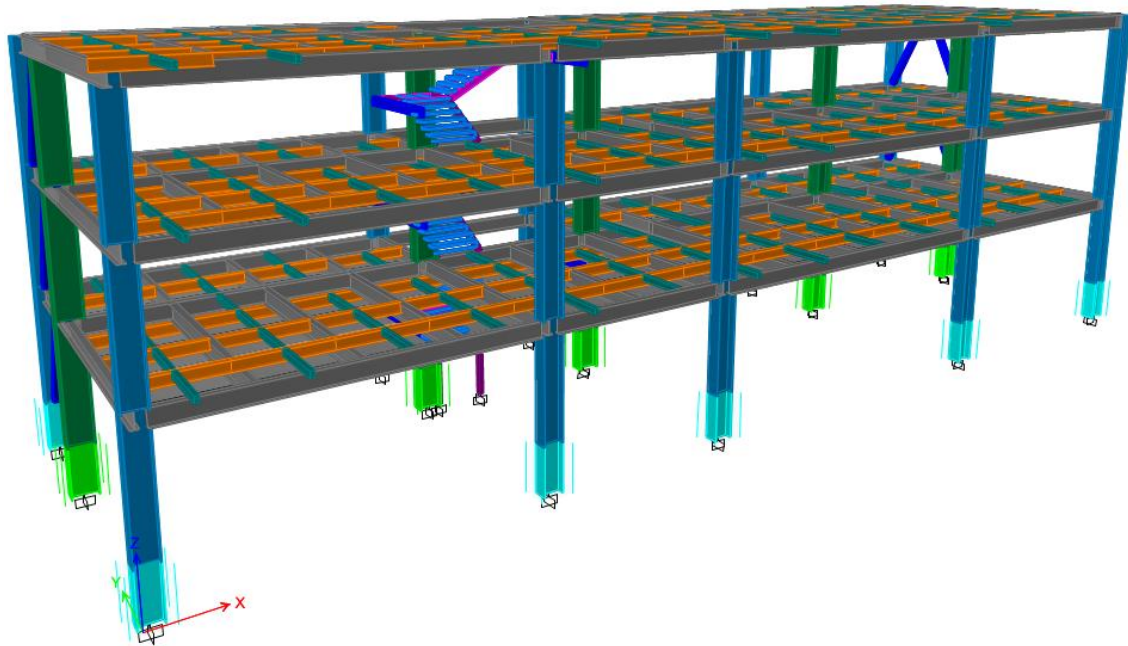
Análisis de la superestructura del Sistema Estructural Mixto – Vista 3 D
